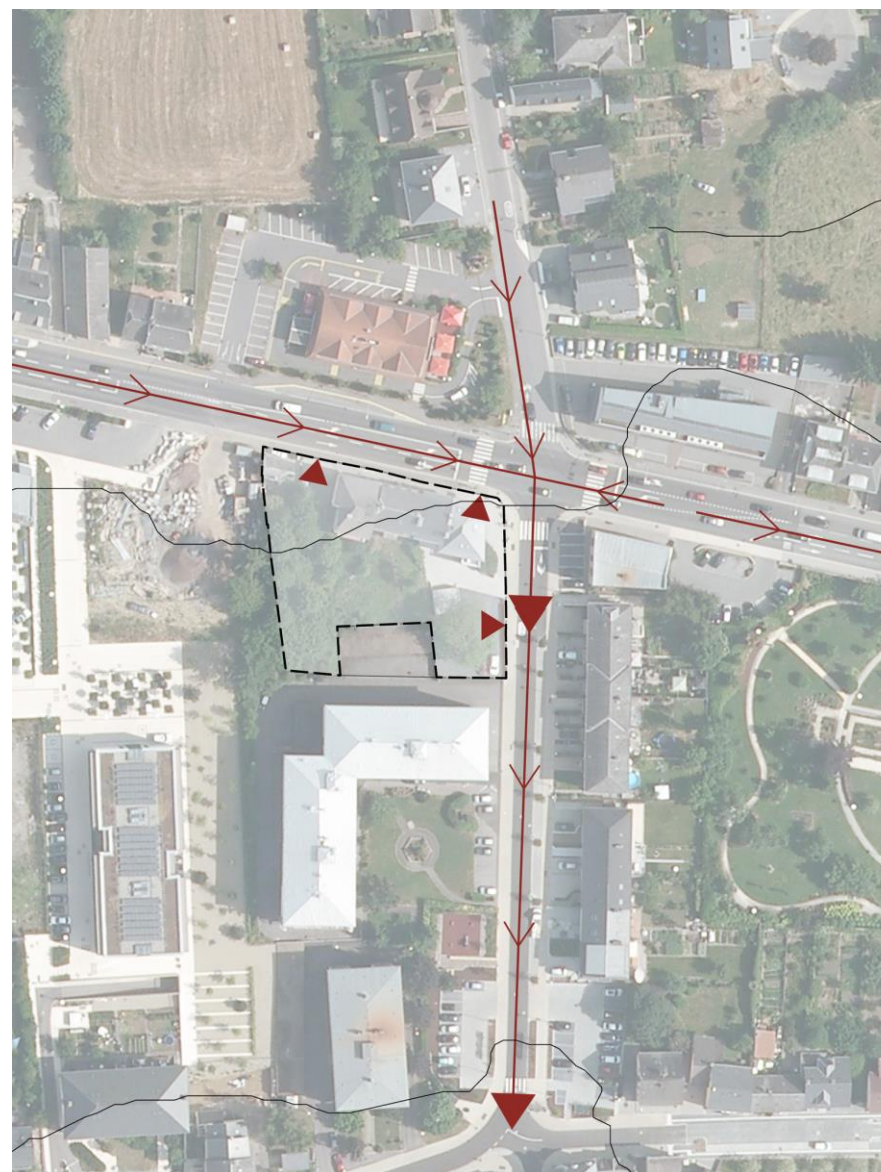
Planung der Schmutzwasserachsen in dem SD-Gebiet, (Grundlage: Orthophoto ACT, 2010)
